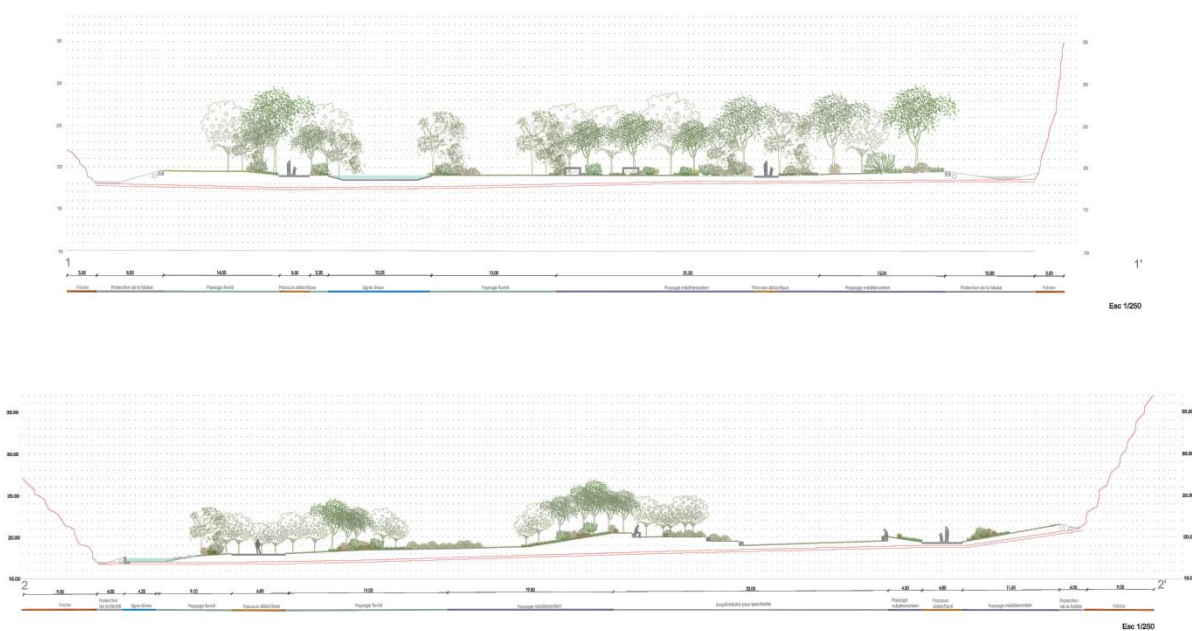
Cortes de Aterro e Escavação 1 e 2
